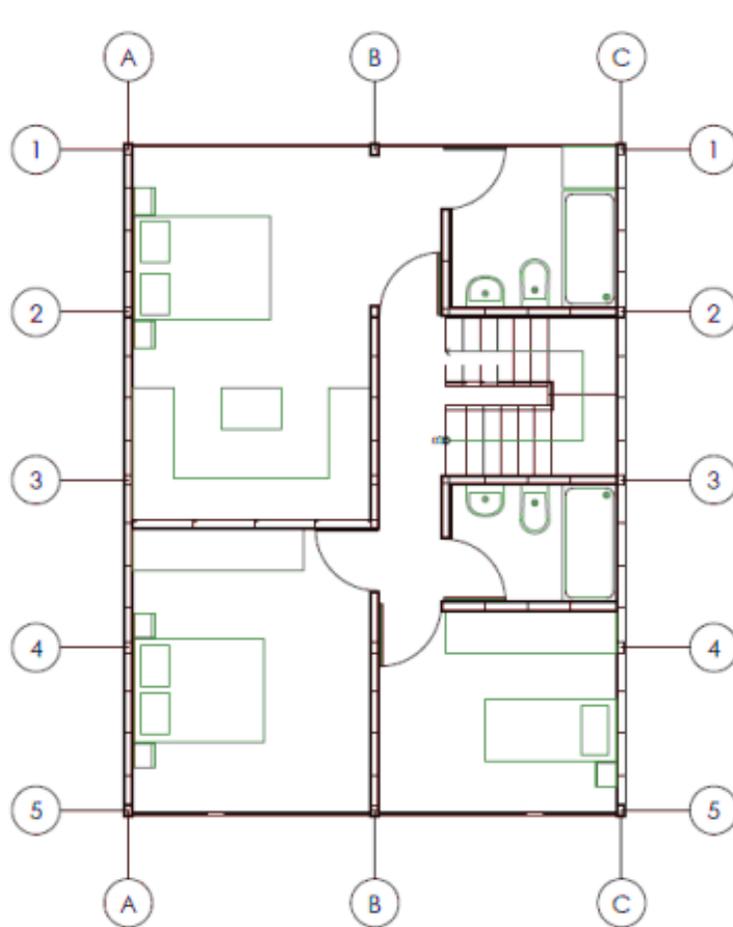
Distribución Arquitectónica de la Planta Alta de la vivienda prefabricada.
